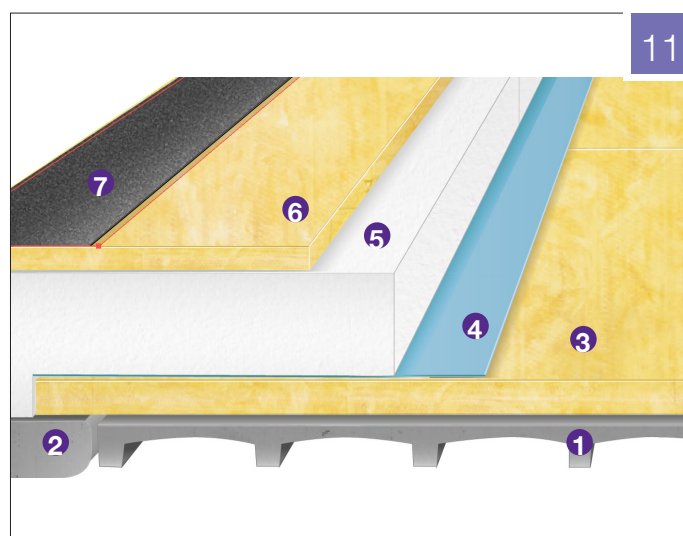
Betontag med hældning isoleret med Jackon tagplader. Underlaget er en sammensat opbygning bestående af vaffelbetonplader og TTS elementer. Henover vaffelbetonpladerne udlægges 25 mm mineraluld med min. 50 mm forskydning i forhold til vaffelbetonpladernes længde- og tværsamlinger.
